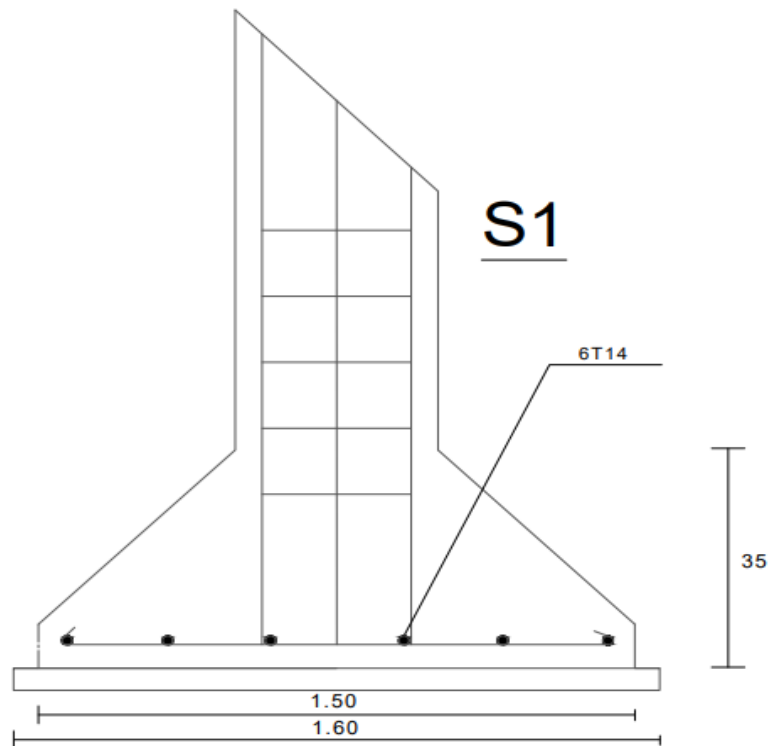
Ferrailage de fondations Group 1 (fondation de centre)
